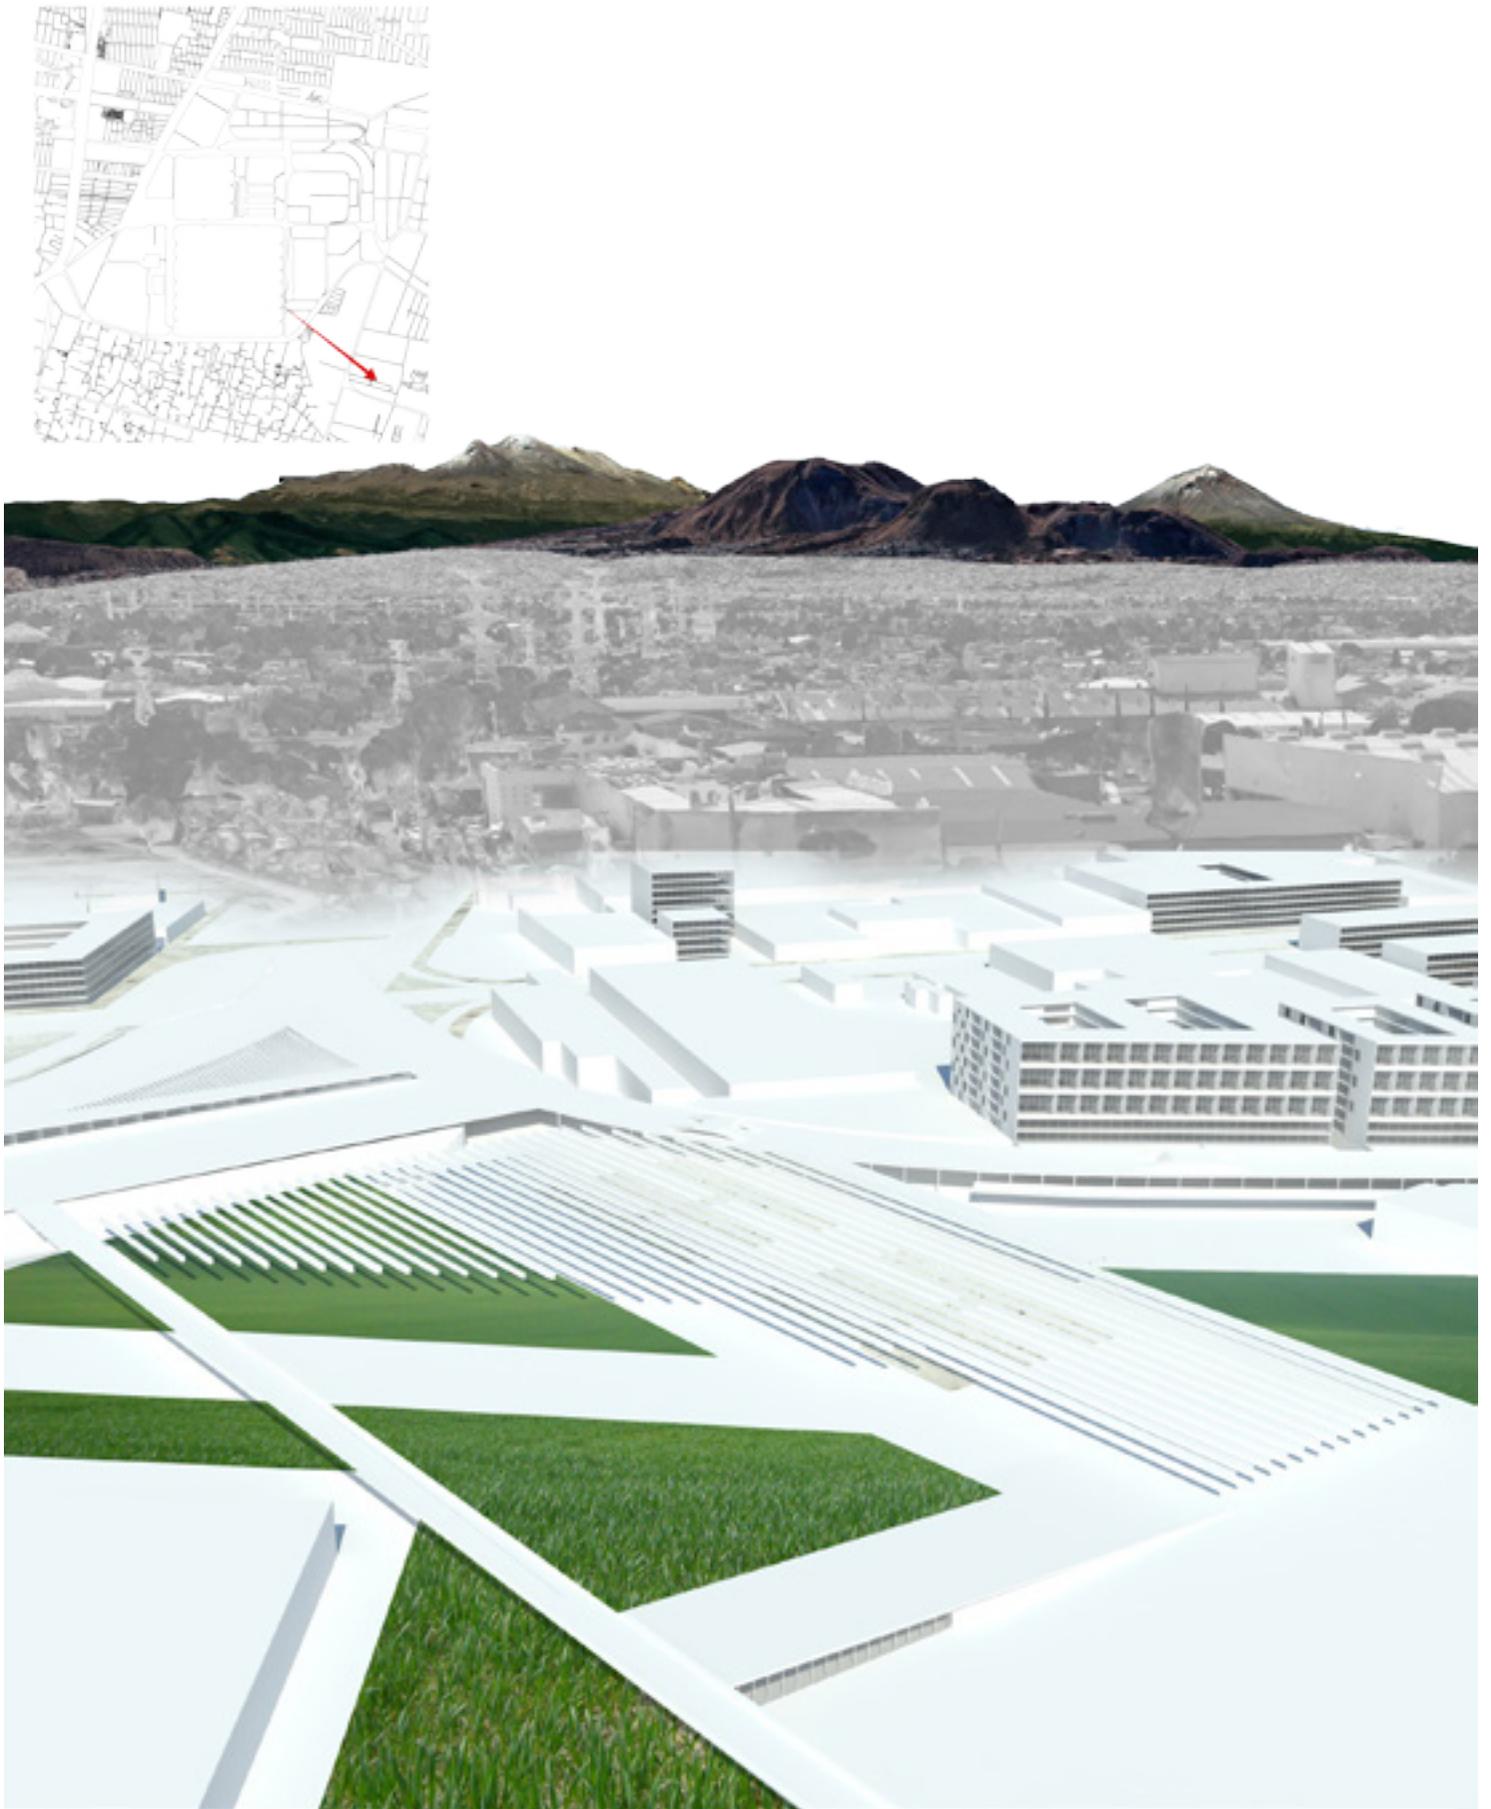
Plan Maestro del proyecto 'Cinturón Programàtico de la Central de Abasto.
